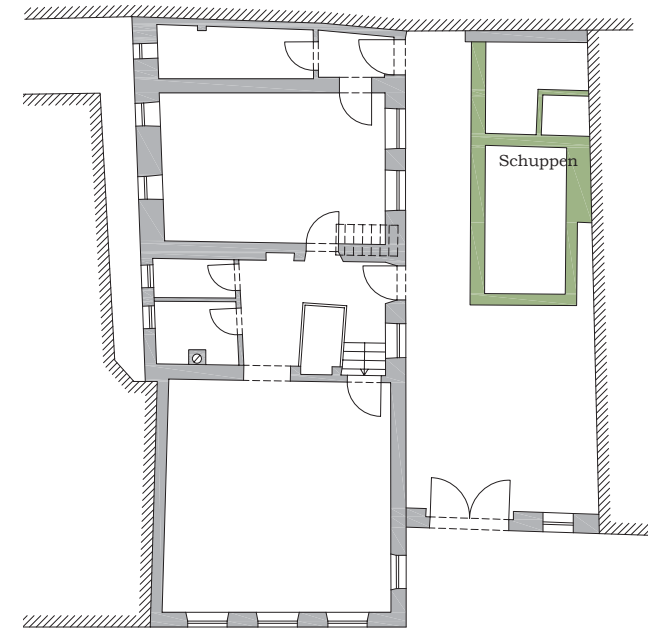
Erdgeschossrekonstruktion vor 1986
